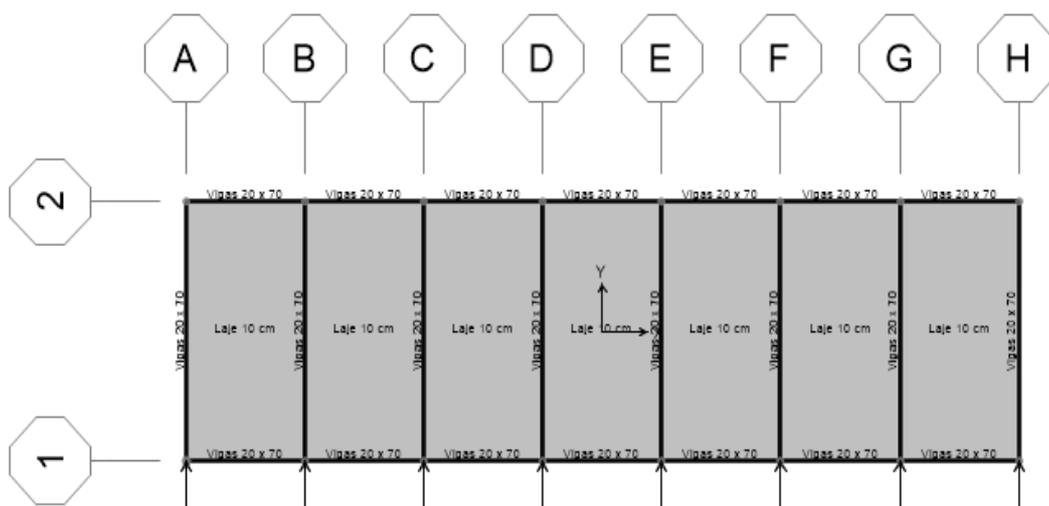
Nomenclatura dos pórticos, dimensões de vigas e lajes e direção de aplicação das forças para geometria retangular.
